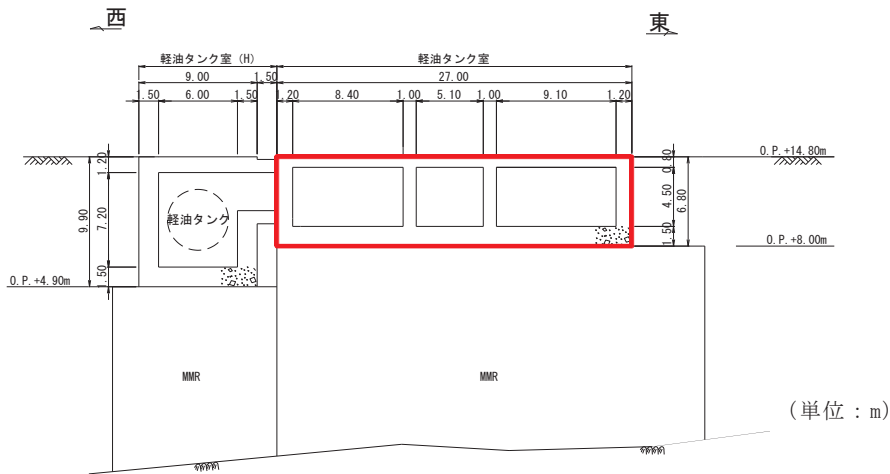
軽油タンク室断面図 (C-C 断面, 東西 (ポンプ室))
